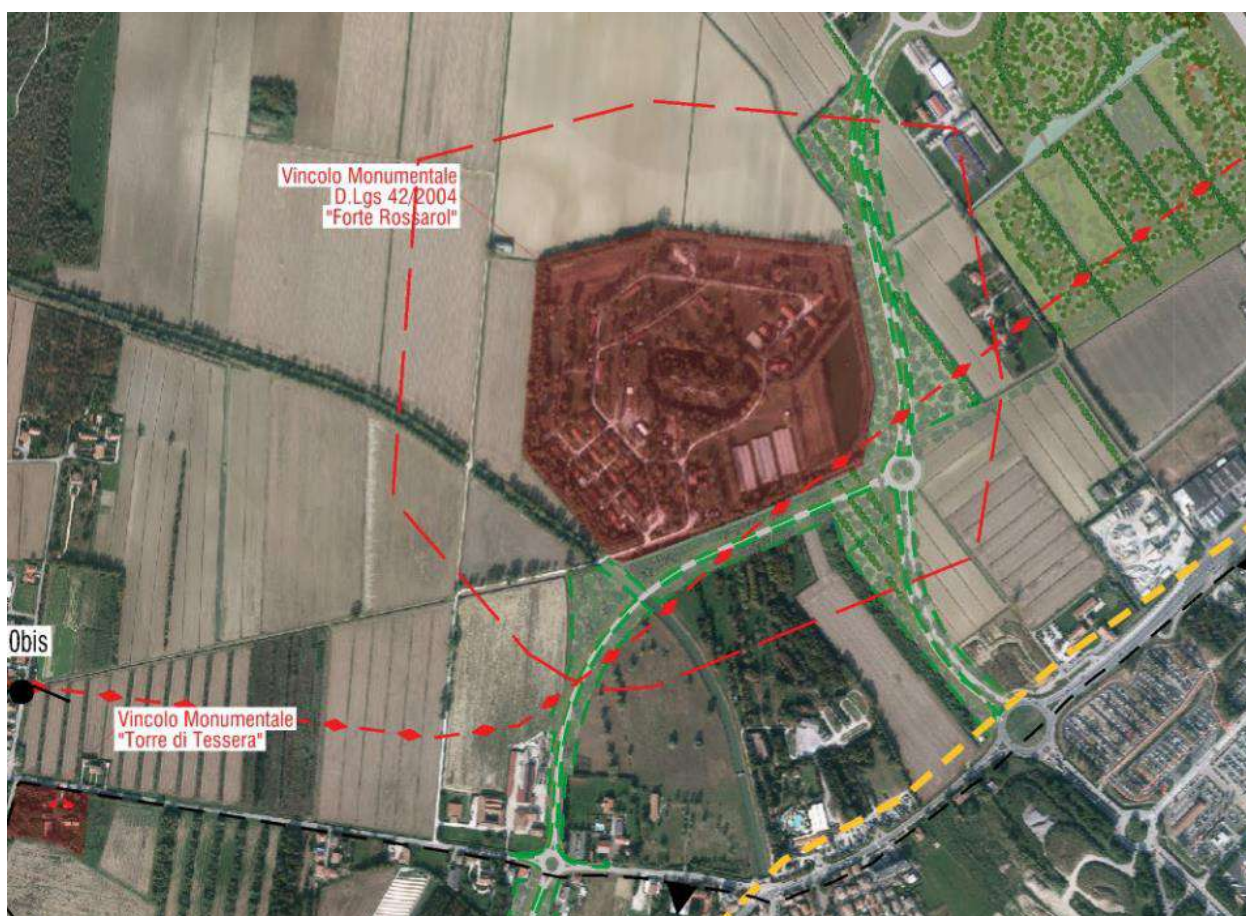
Forte Rossarol e fascia di rispetto di 200 con individuazione della viabilità di progetto
